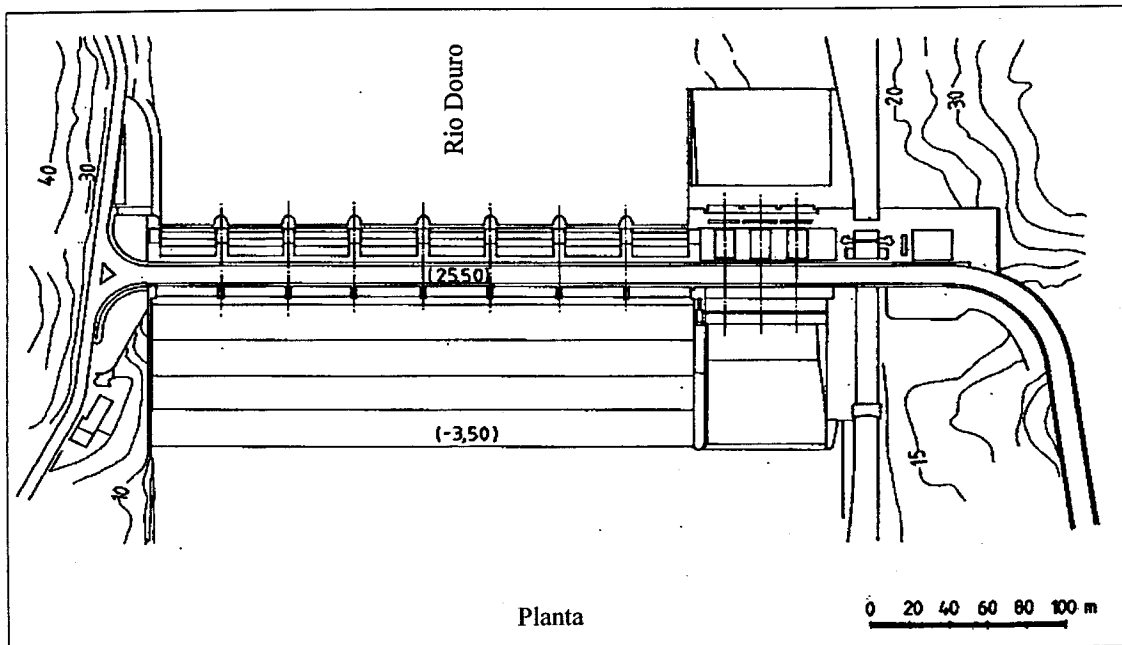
Planta da barragem do aproveitamento de Cretuma-Lever, Portuguese National Committee on Large Dams 1992 (pg. 104)
